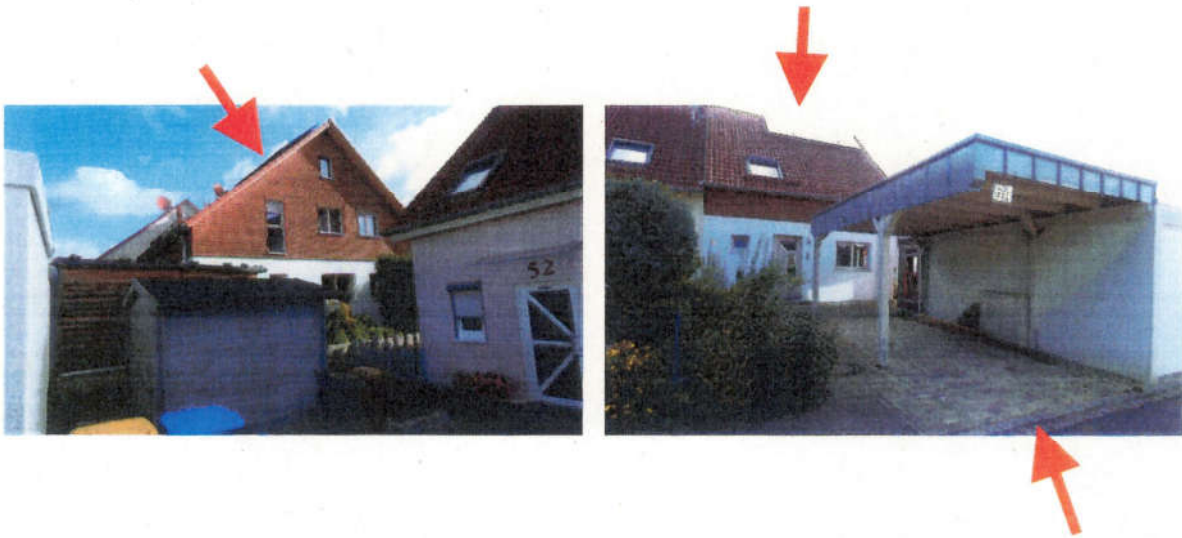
Außenansichten Gebäude und Grundstück (ff.)
